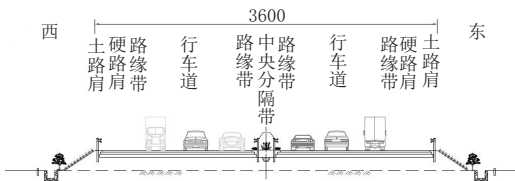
横断面布置图(起点—俞汇互通合流段)(单位:mm)
